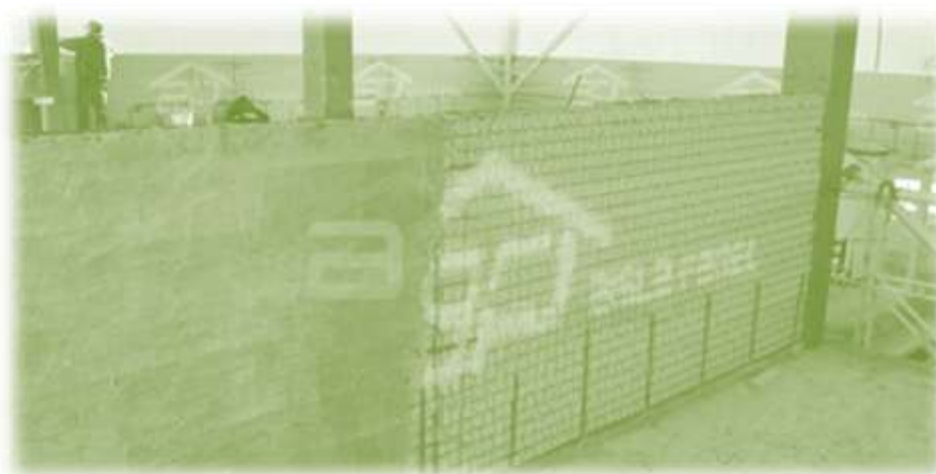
, Aislapanel; <http://guadalajara.olx.com.mx/aislapanel-s-a-de-c-v-iid-309422987>
